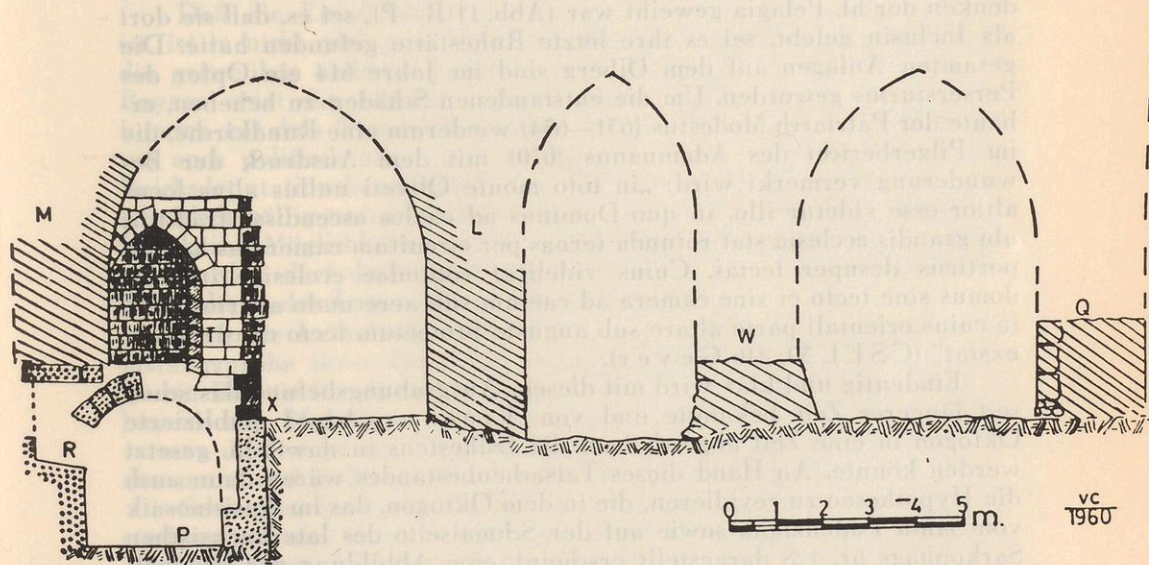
Jerusalem: Ölberg, Schnitt C—D (vgl. Plan I).
